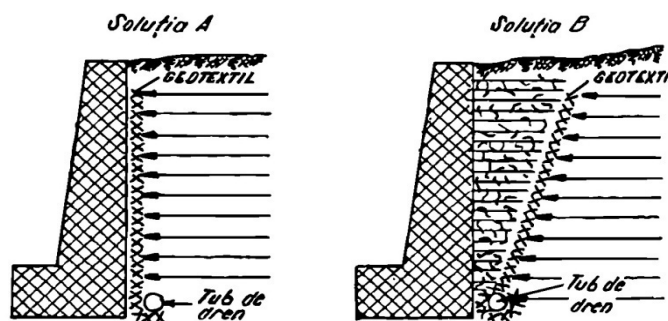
Sisteme de drenaj cu geotextile în spatele zidurilor de sprijin
